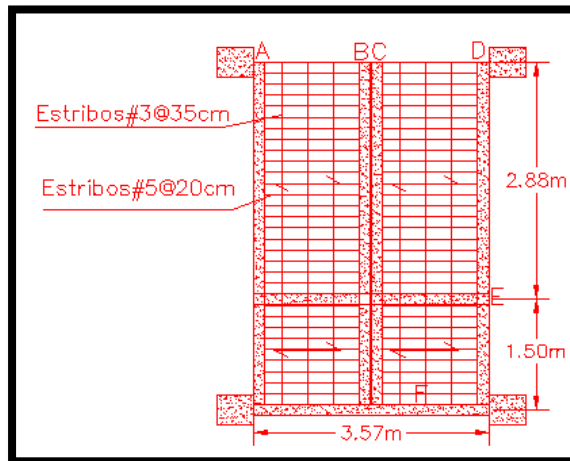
Modelo de losa para escalera con distribución de acero de refuerzo.
